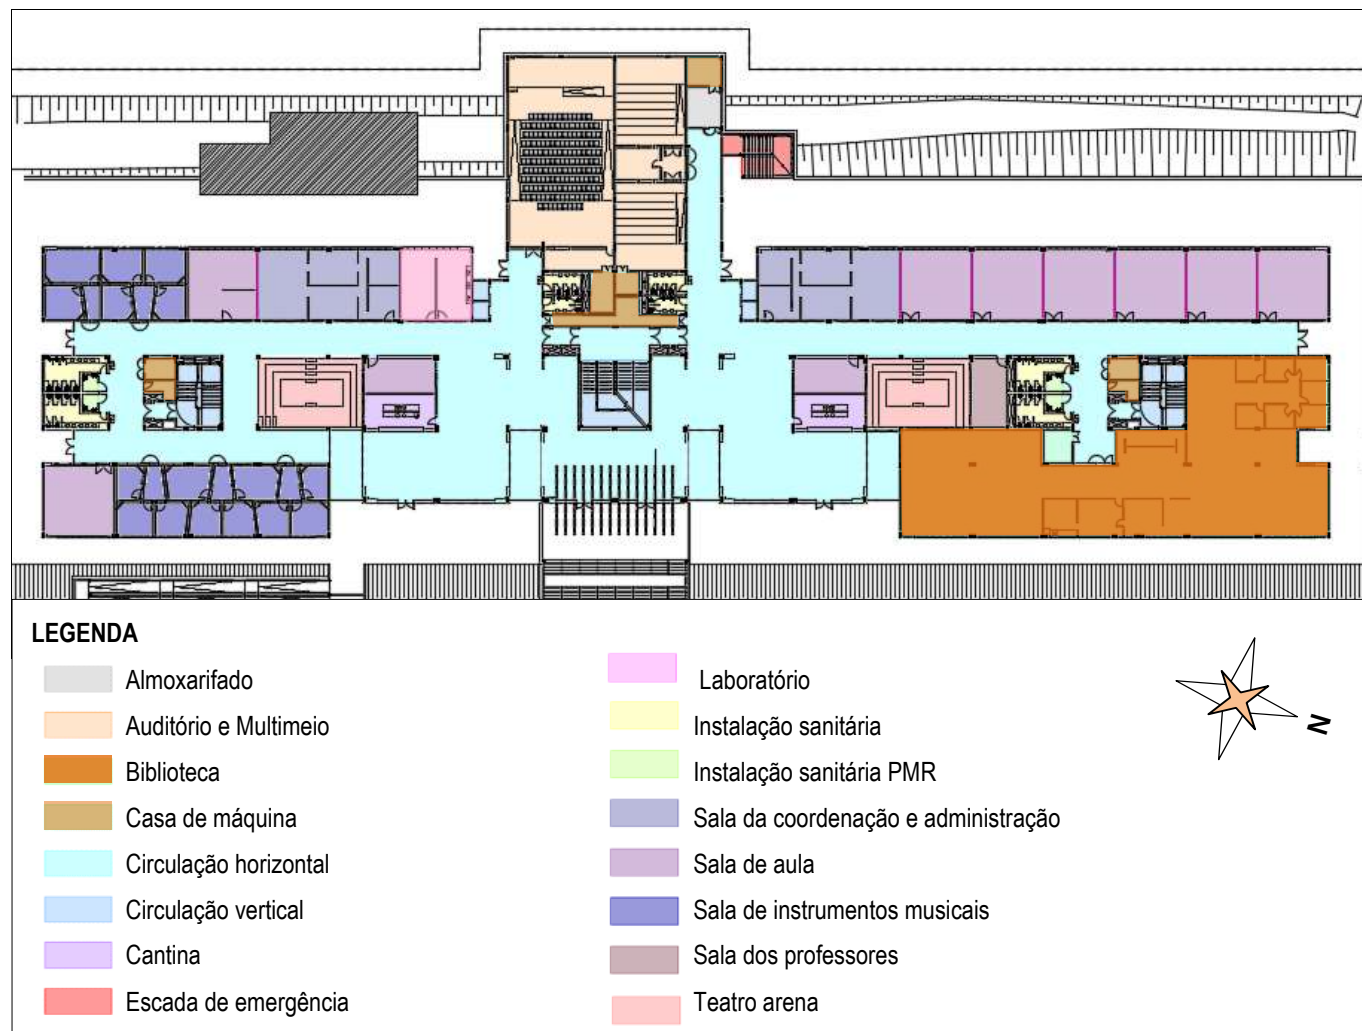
Planta setorizada do pavimento térreo do bloco 07.
